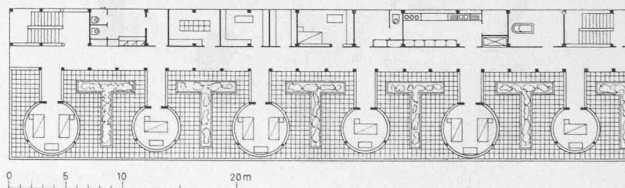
Beobachtungsstation mit runden Krankenzimmern (als Dachgeschoss eines Gross-Krankenhaus), 1:600. Entwurf F. LOEWIG
